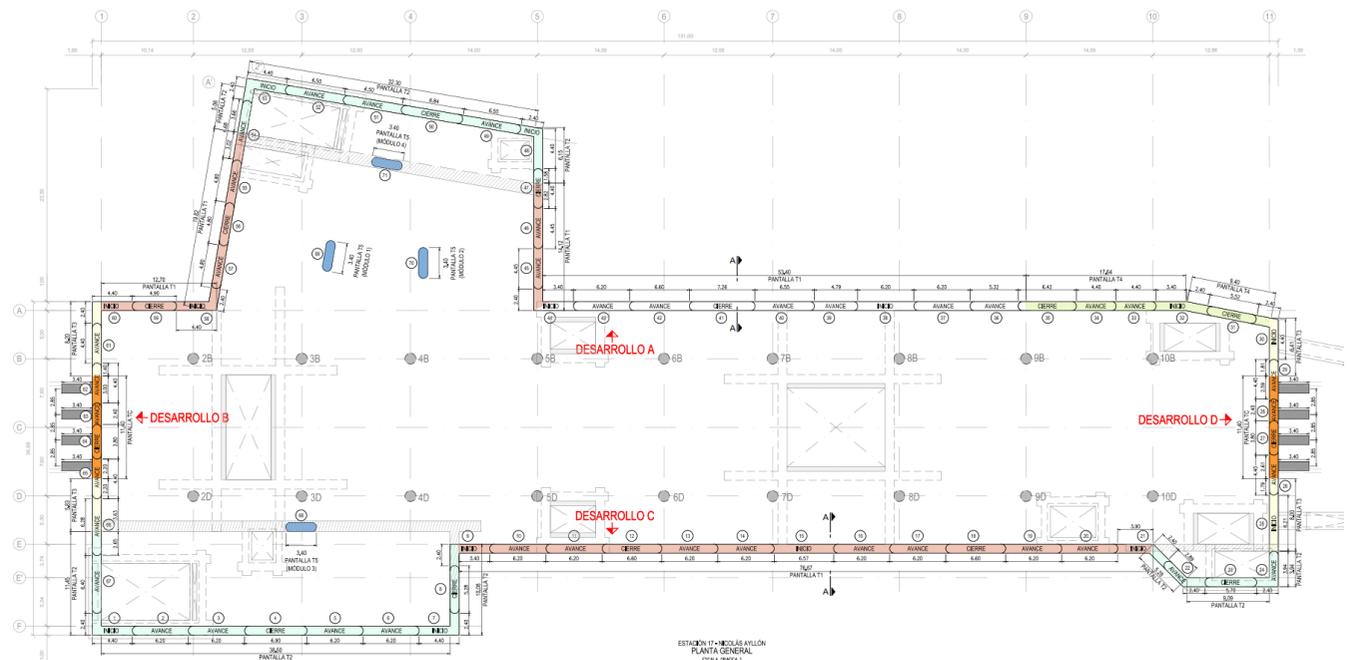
Plano de planta de la Estación 17-“Nicolás Ayllón”
